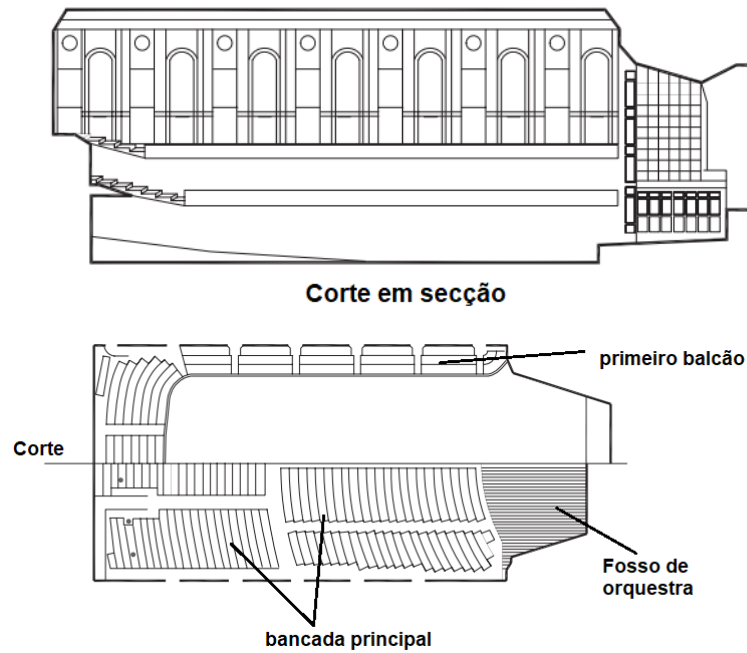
Planta e corte em secção do *Boston Music Hall* [adaptado de 8].
